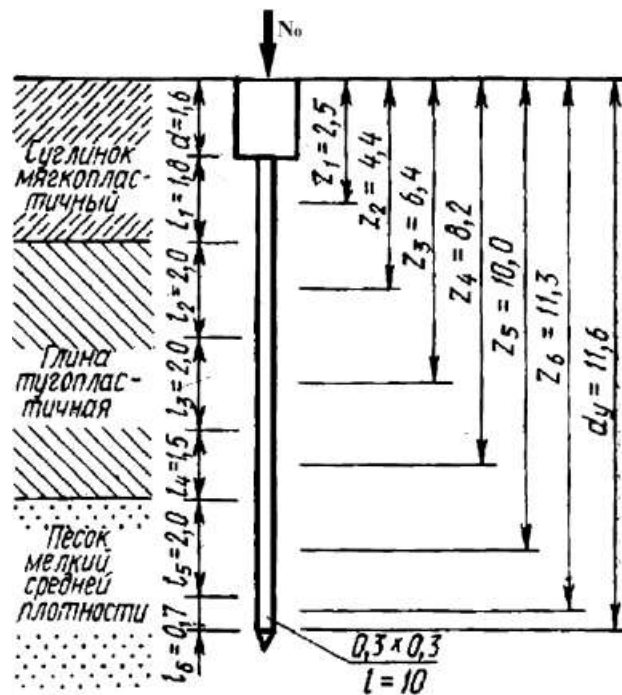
Схема напластований грунтов к определению расчётной нагрузки на сваю (размеры в м)
